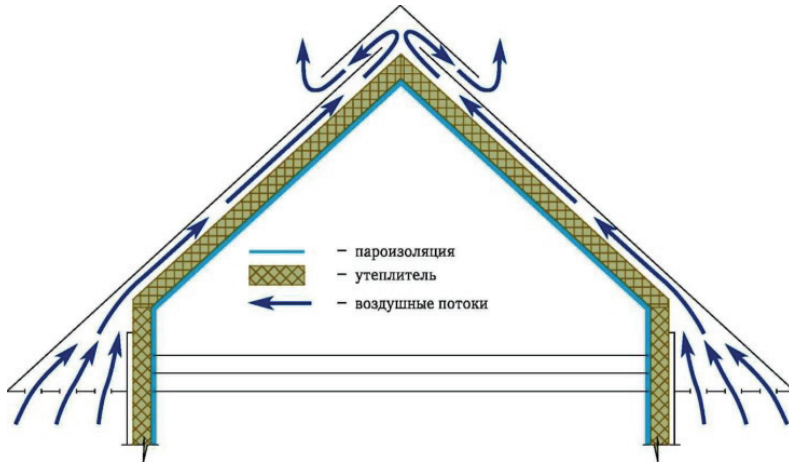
Схема утепления, пароизоляции и вентиляции мансарды
